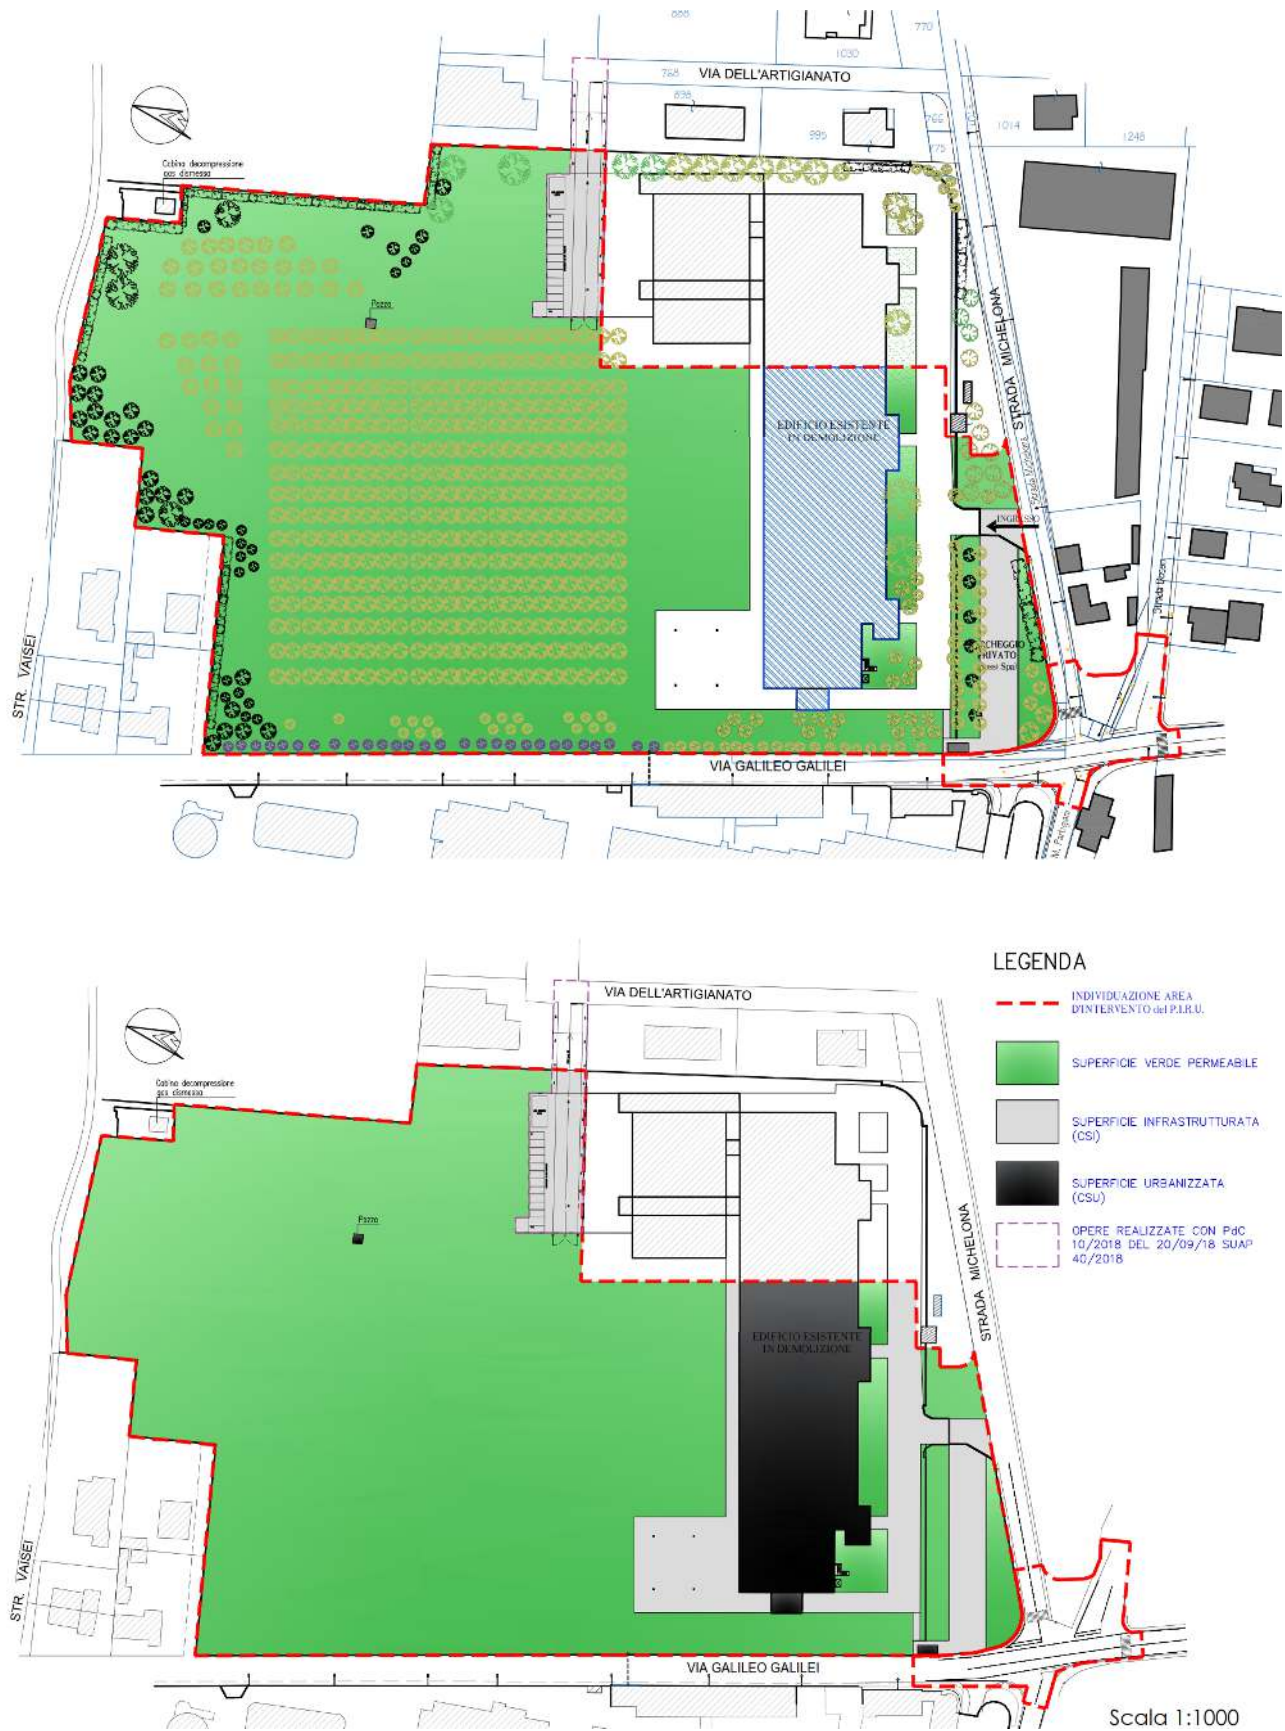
Planimetria dello stato di fatto con rilievo delle alberature e dell'occupazione del suolo
